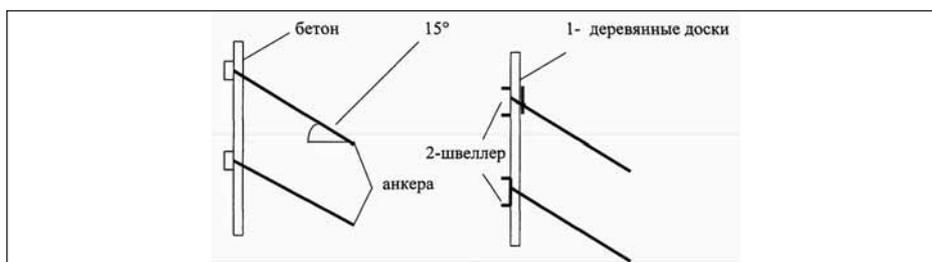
Рекомендуемые типы крепления стен выработок тоннелей для скального грунта
